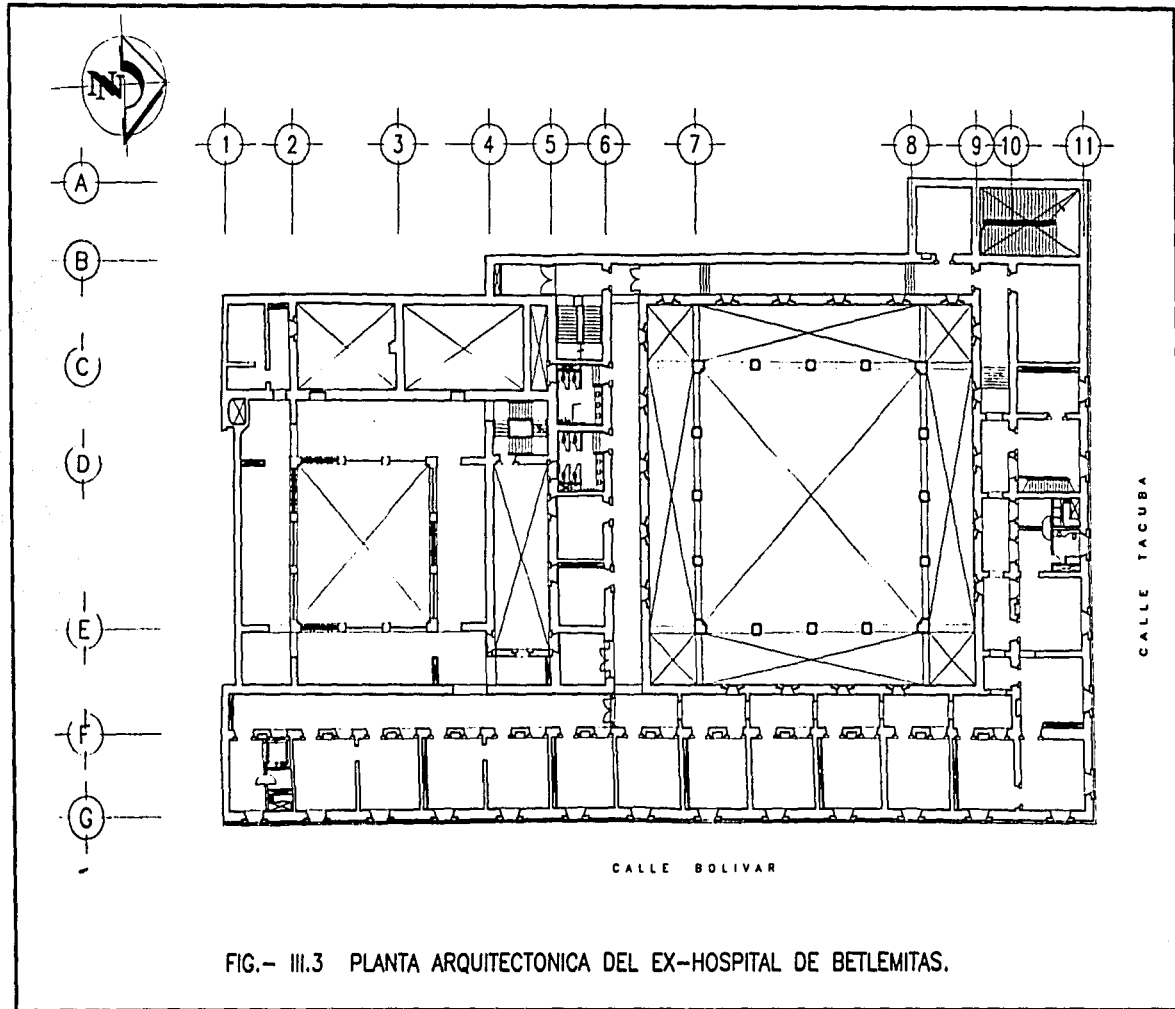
PLANTA ARQUITECTONICA DEL EX-HOSPITAL DE BETLEMITAS.
